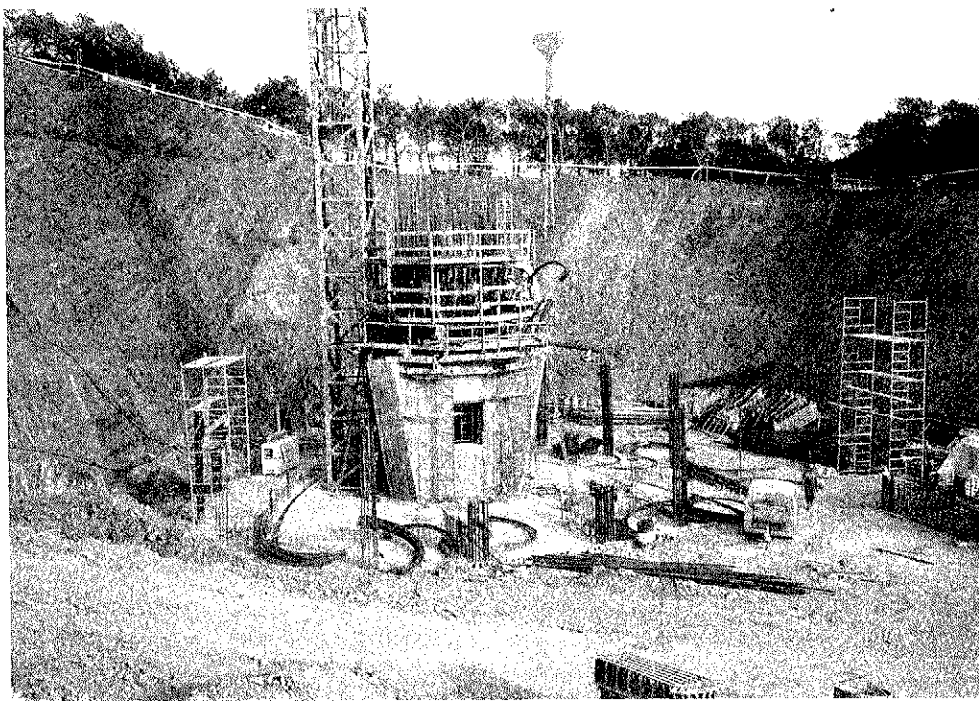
Armaduras zona inferior fuste. (detalle zona acceso).
